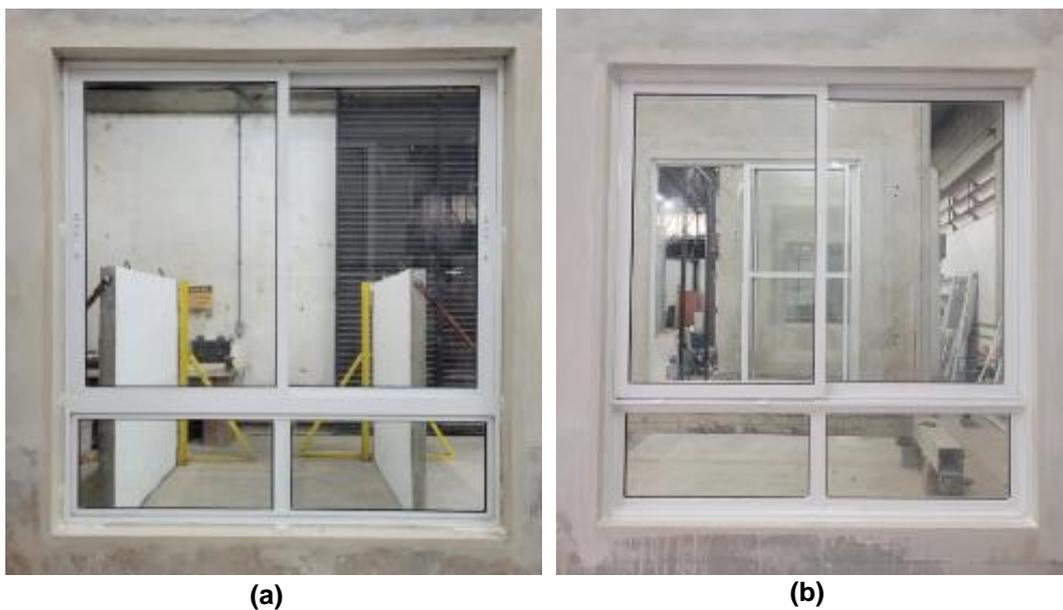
Vista da esquadria instalada: (a) interna, e (b) externa
